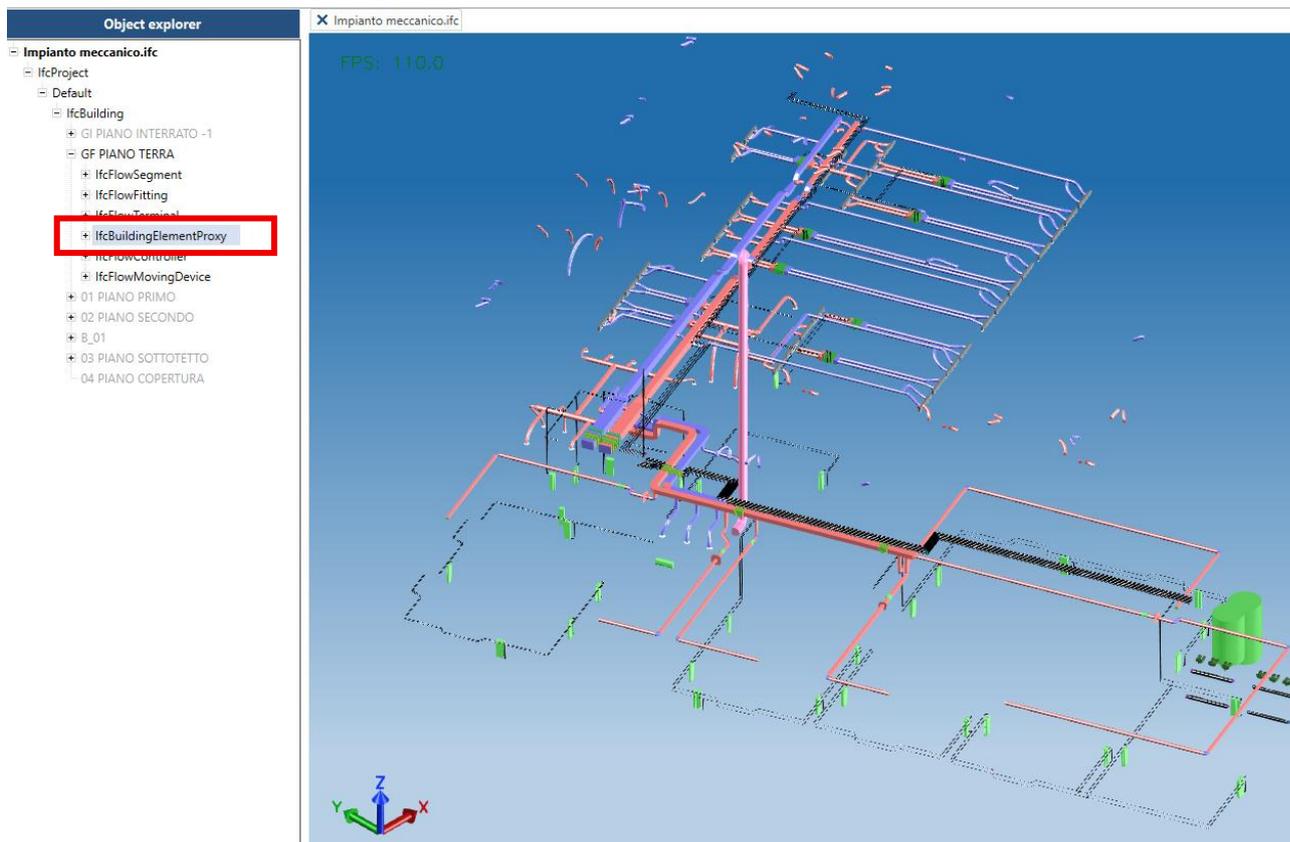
Elementi IfcBuildingElementProxy nell'impianto meccanico
